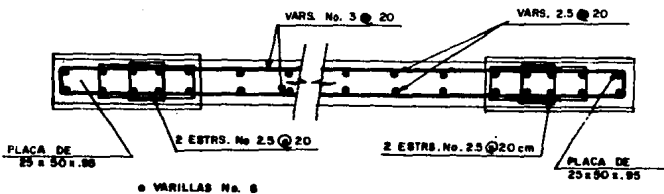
ANCLAJE DE MURO CON REFUERZO SOLDADO A PLACAS METALICAS
